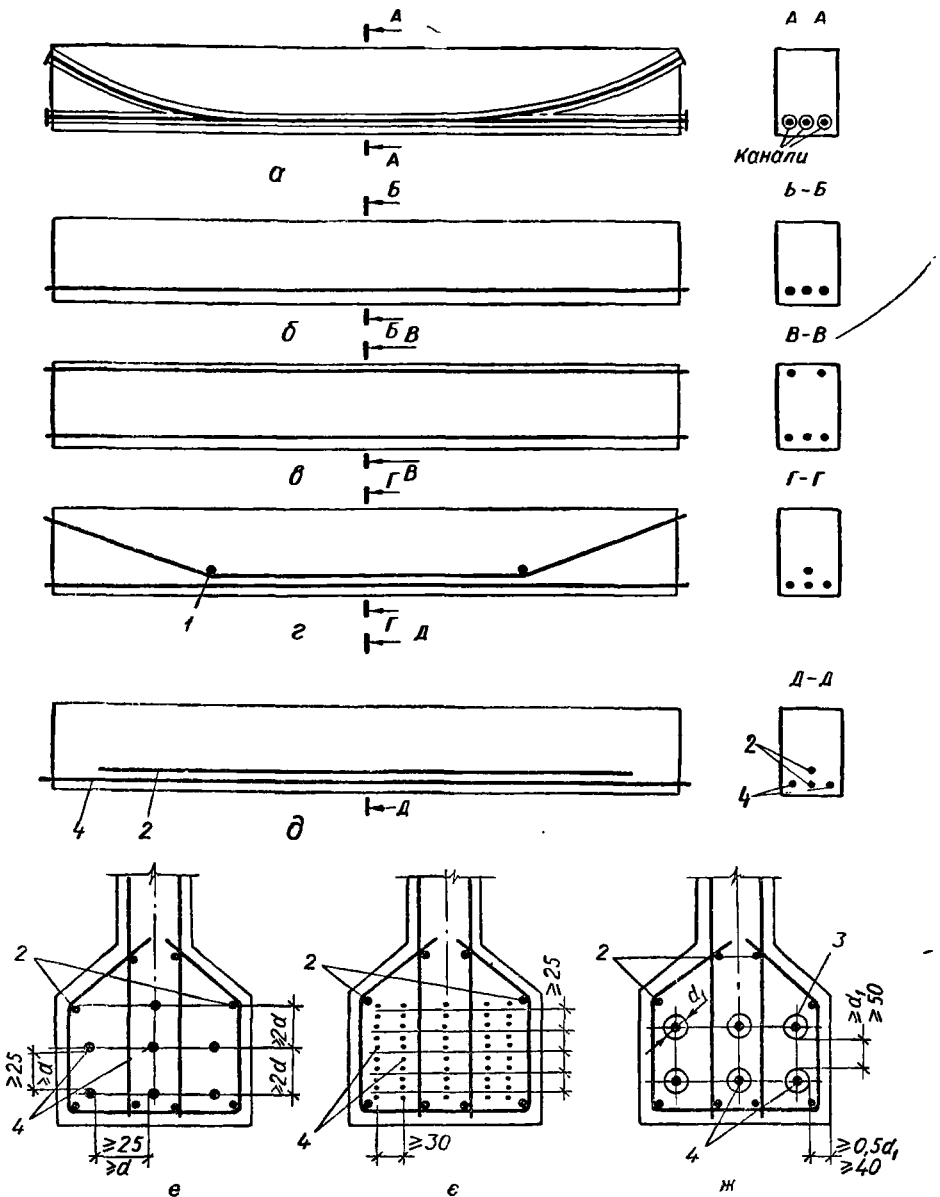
Арматура попередньо напружених балок напруженою арматурою:
